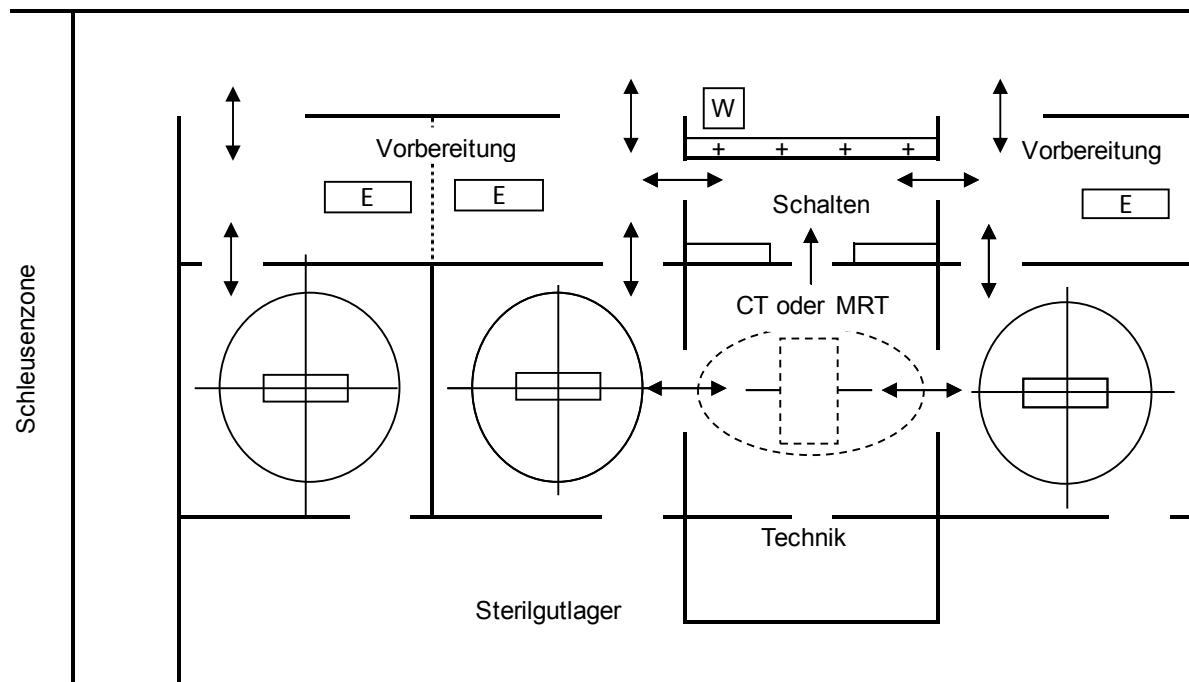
Systemgrundriss Hybrid-OP mit MRT
